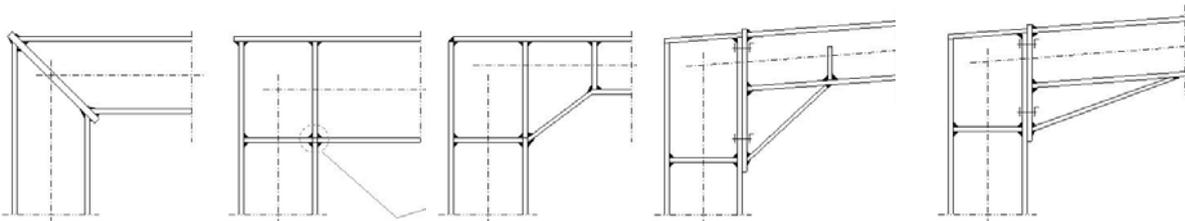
Schematische Darstellung für die Ausführung von Rahmenecken
